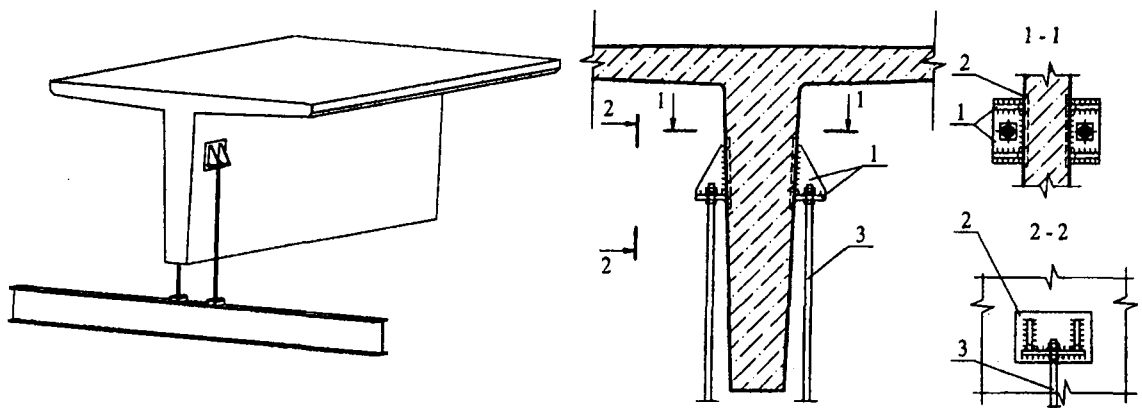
Вариант крепления путей подвешного транспорта к плитам Т и ТТ:
